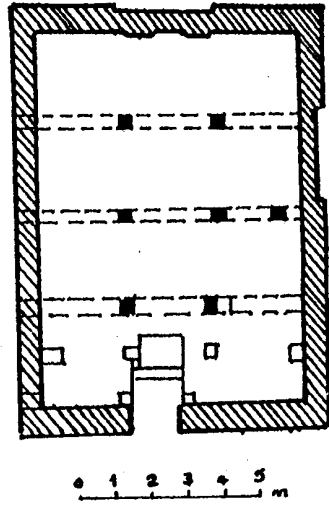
مسقط أفقي للجامع الفاطمي بدير سانت كاترين
